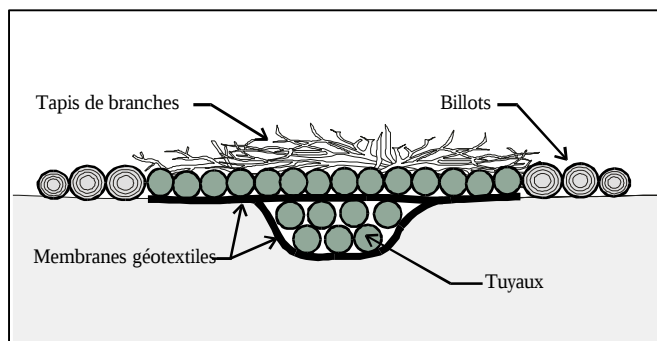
Coupe transversale de la structure utilisée au 1^{er} essai
